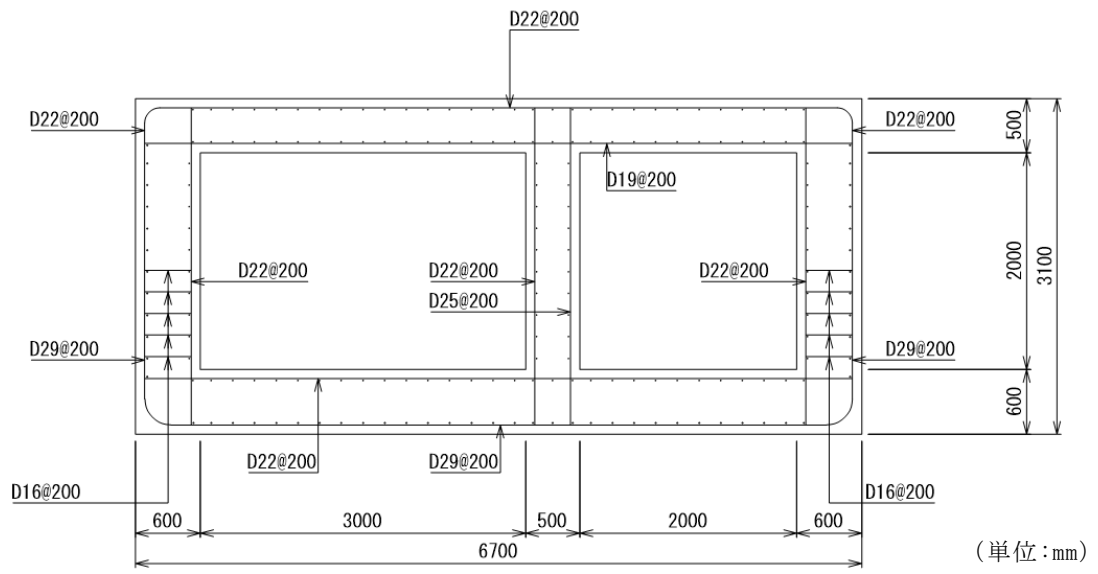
屋外配管ダクト（タービン建物～排気筒） 概略配筋図
